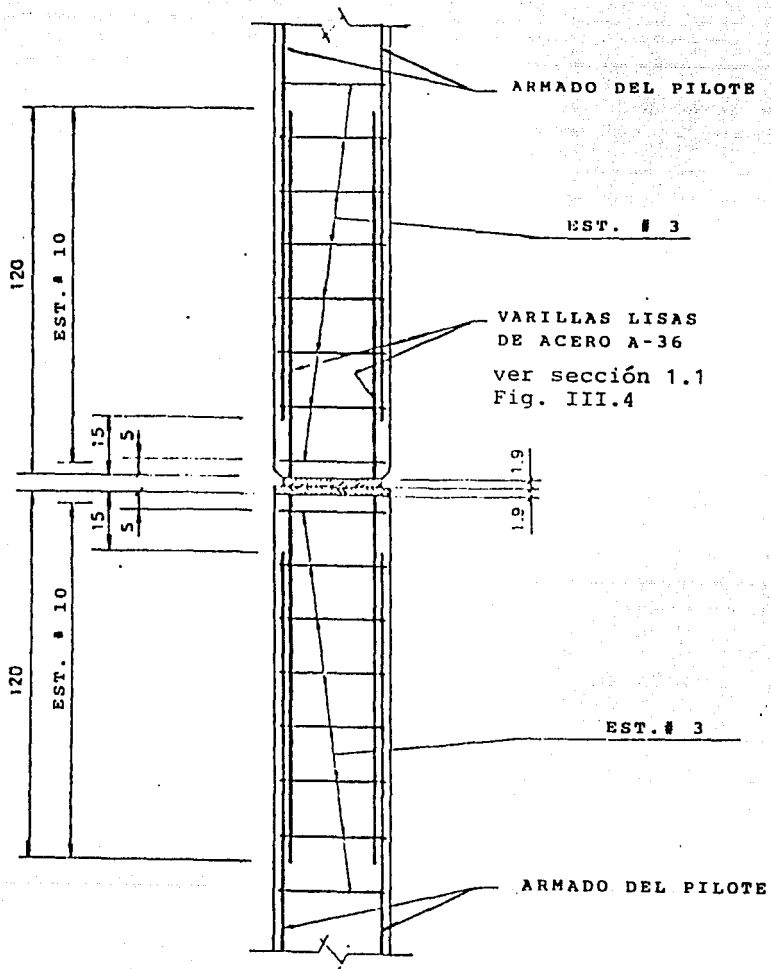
TRASLAPE DE VARILLAS Y JUNTA ENTRE TRAMOS DE PILOTES.
